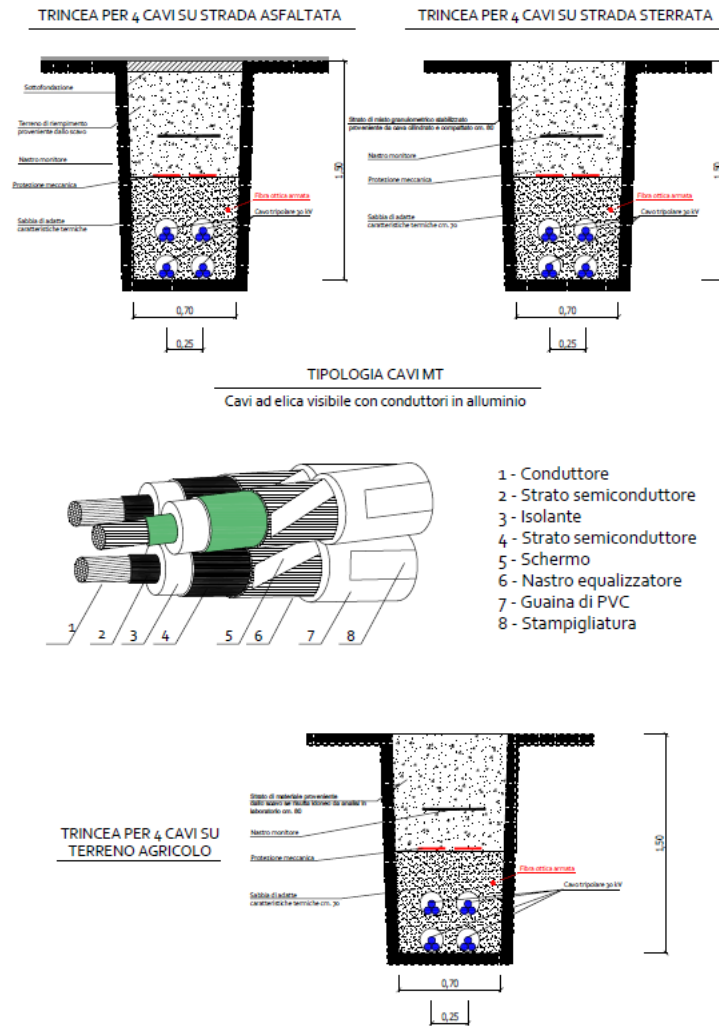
Sezione della trincea di scavo per la posa dei cavi da 30 kV di collegamento dall'impianto FV alla Stazione di Elevazione
